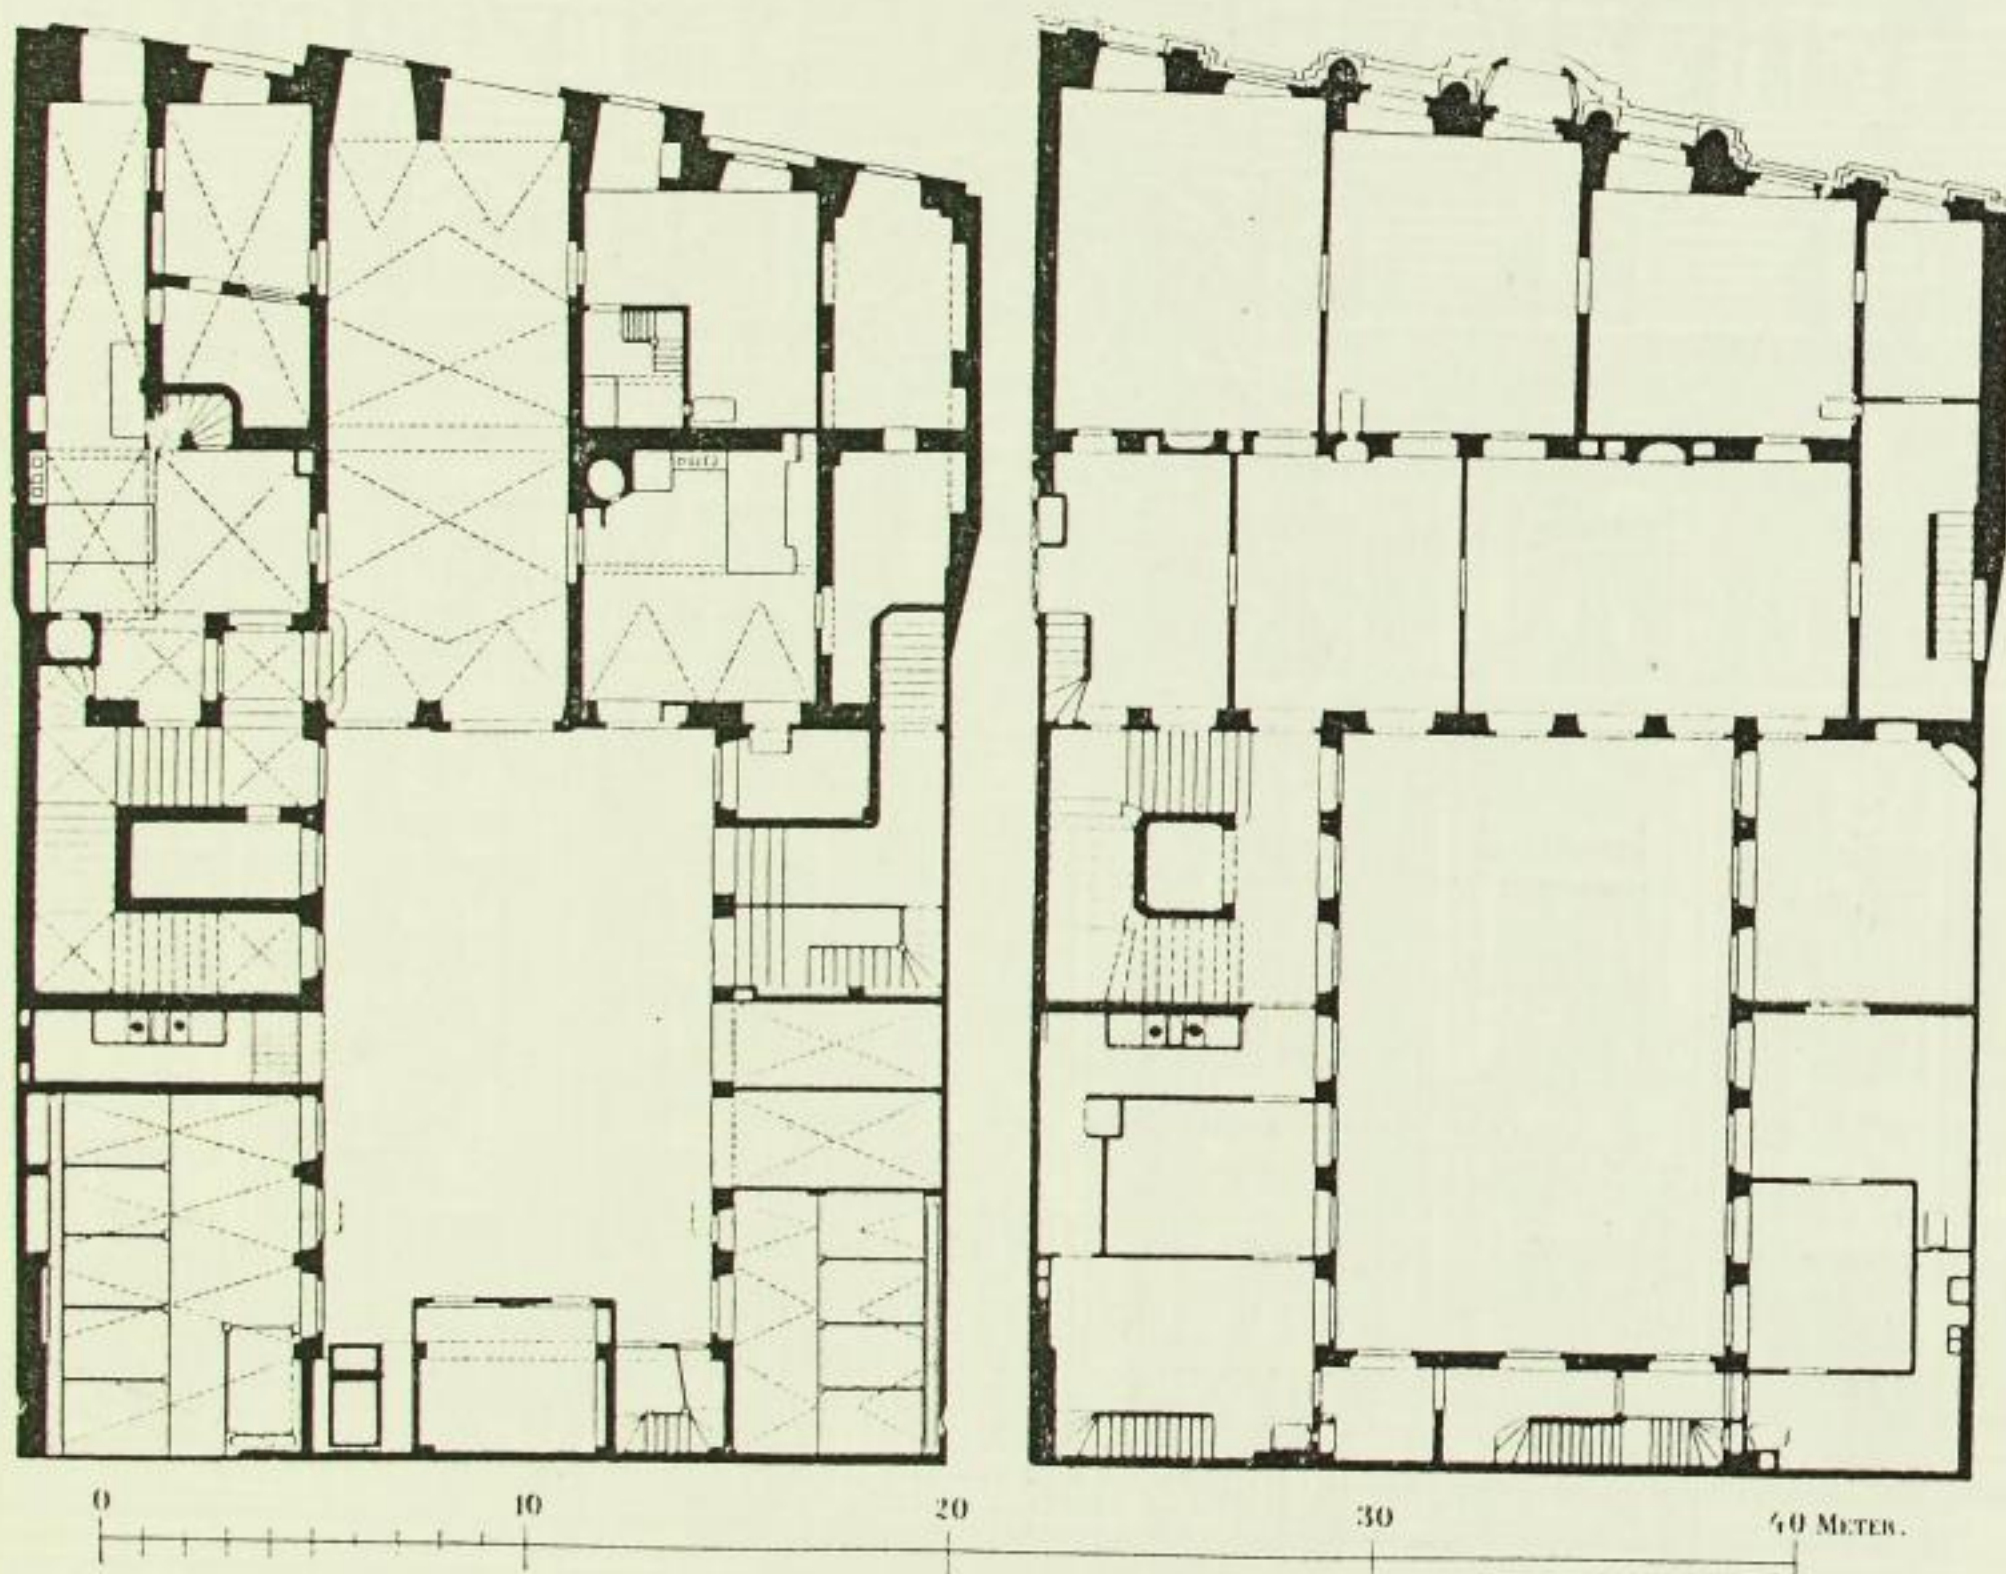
und 395. Hôtel de Saxe, Grundriss des Erd- und Hauptgeschosses. Zustand nach 1764.
